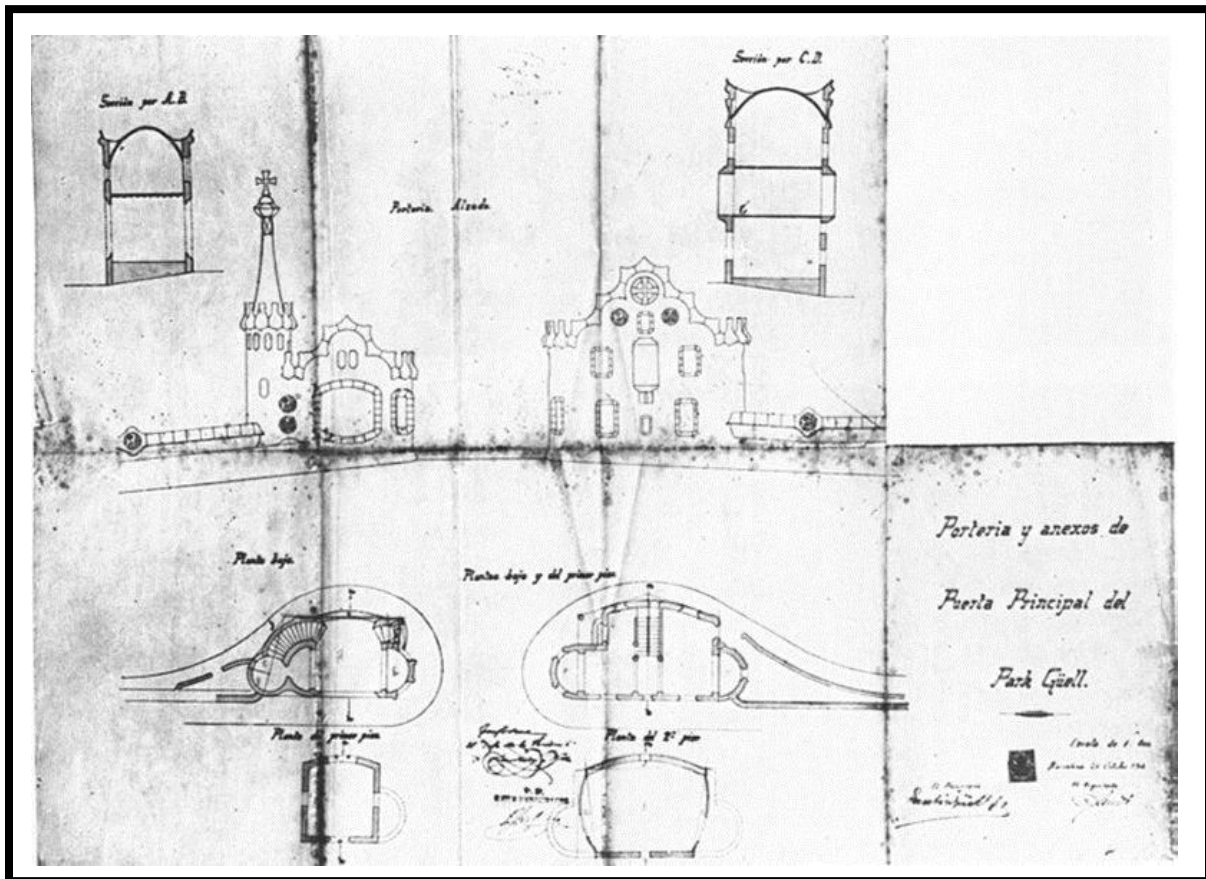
Planta y alzado de los pabellones de entrada al parque, firmados por Gaudí (1904)
